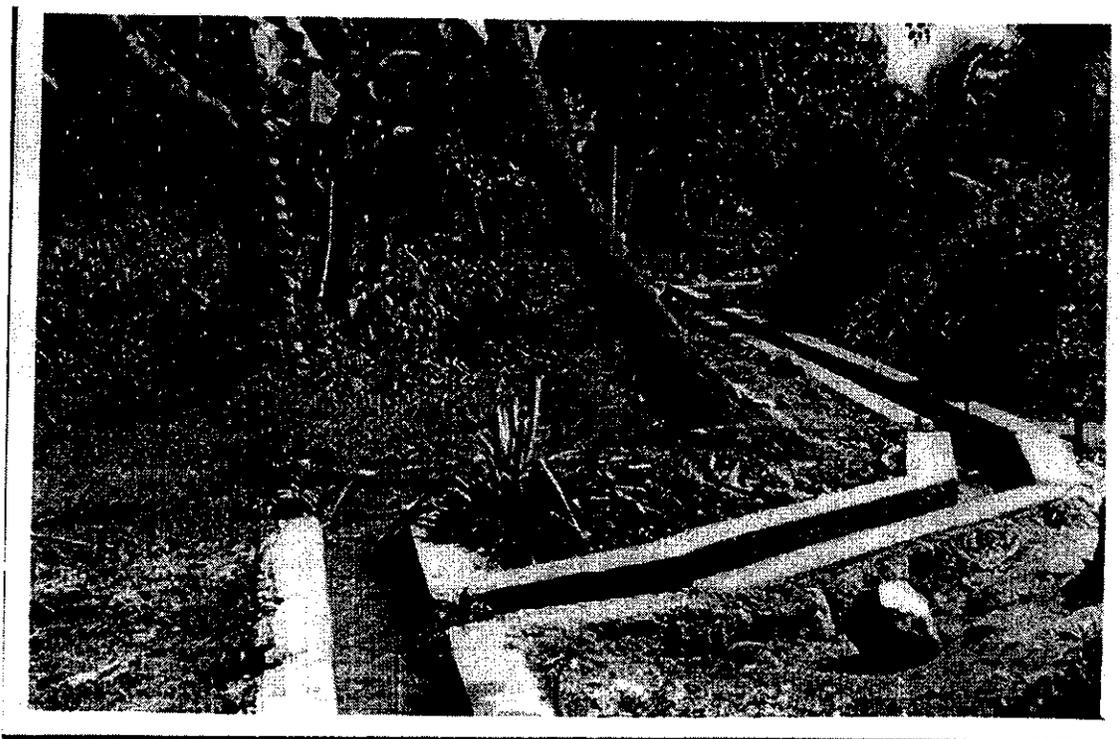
Vue du Canal Demontreuil (Anbarak) construit à Orangers
